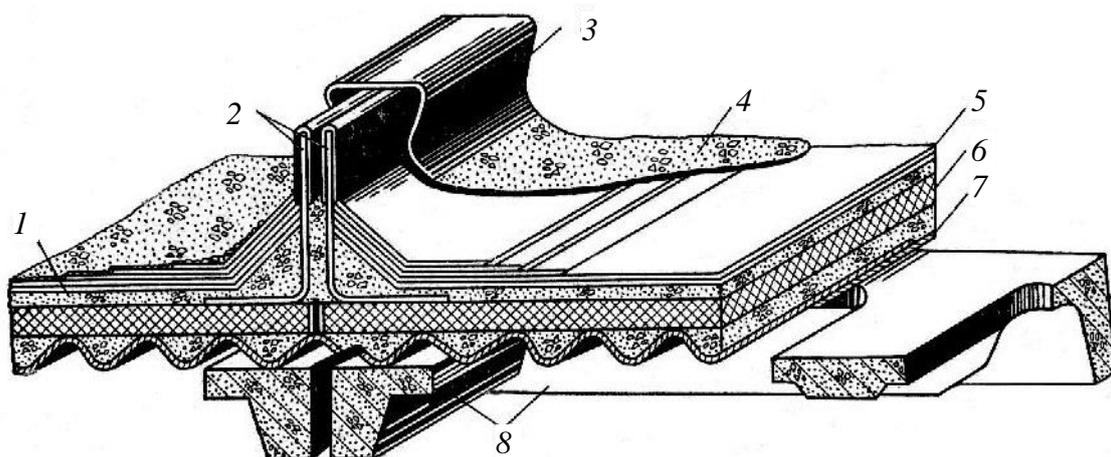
Схема устройства раскрывного шва в покрытии легкобрасываемой кровли:
